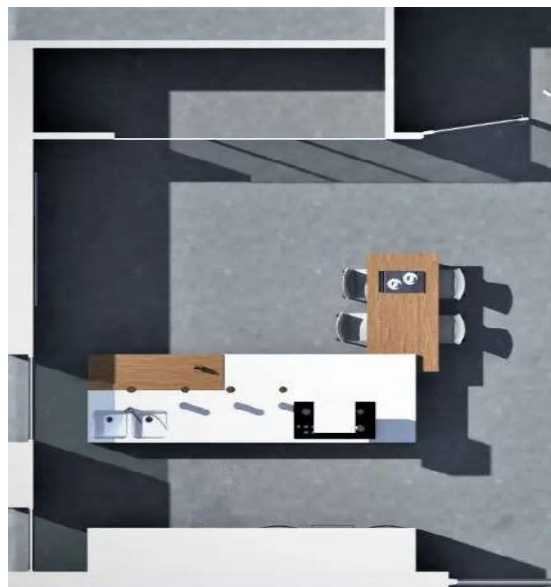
Esempio schema planimetrico di cucina⁴⁸
